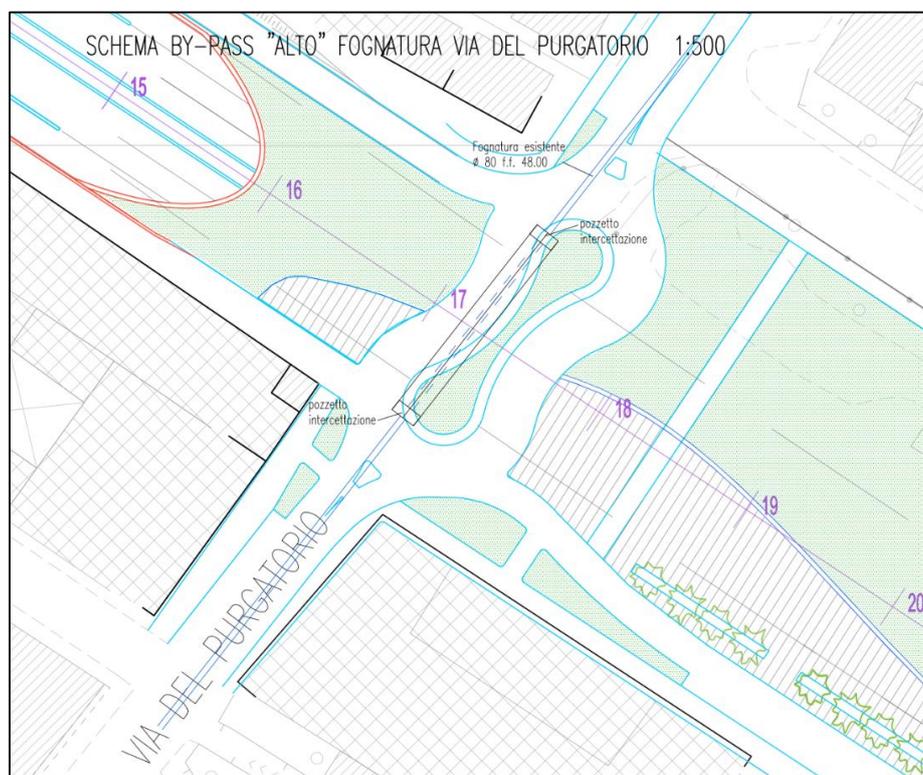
Pianta tubo 800 mm lungo Via Purgatorio
